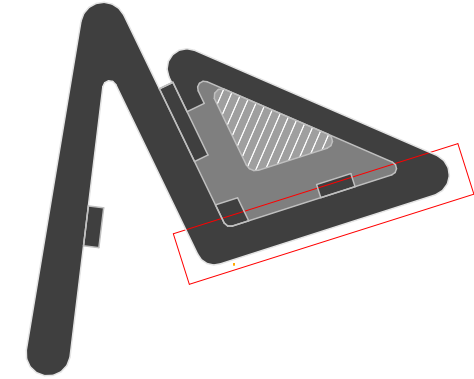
, Schema Fassadenkonstruktion, eigene Darstellung
